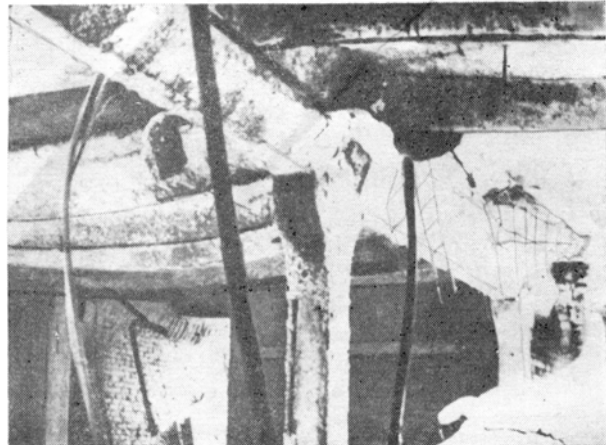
Пошкоджені конструкції перекриття та колони після впливу вогневого навантаження [3]
